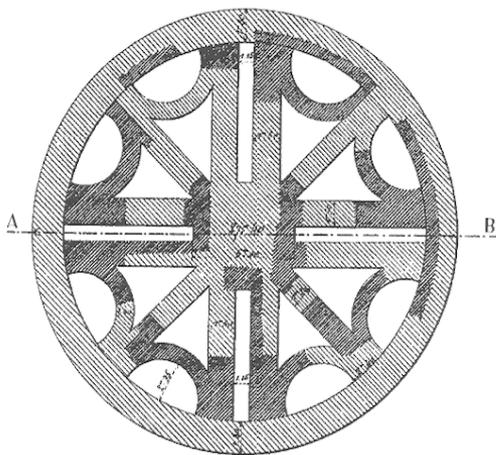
Plan du monument funéraire dit la Gironette (Roidot-Deléage, 1878, pl. XXIX).
